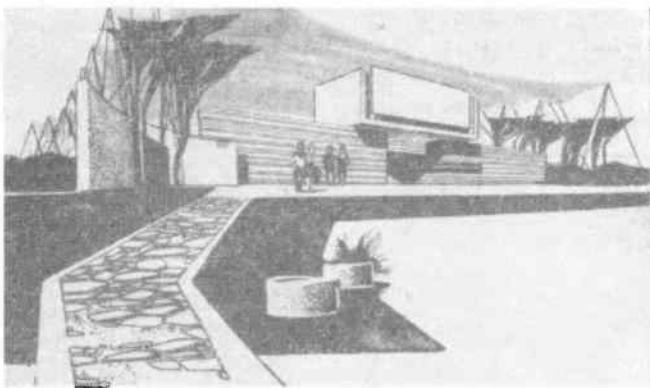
Главный фасад летней киноплощадки на 800 мест
